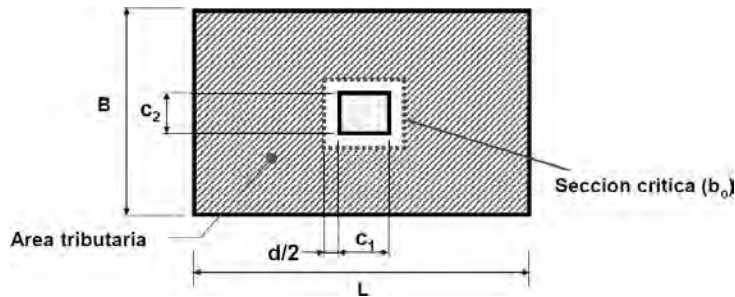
1. Sección crítica para la verificación por punzonamiento en zapatas
